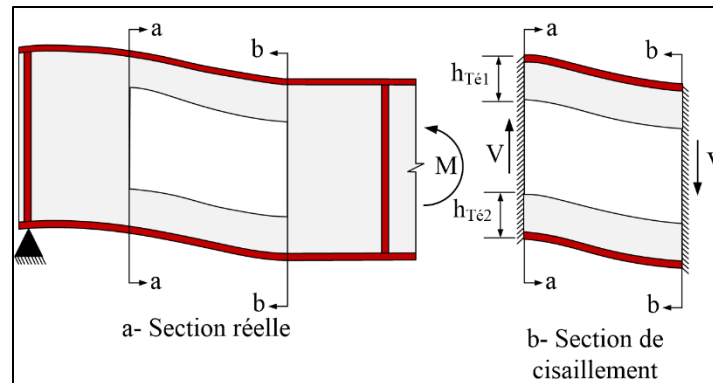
Sections de poutre pour le modèle de Roark [52]
